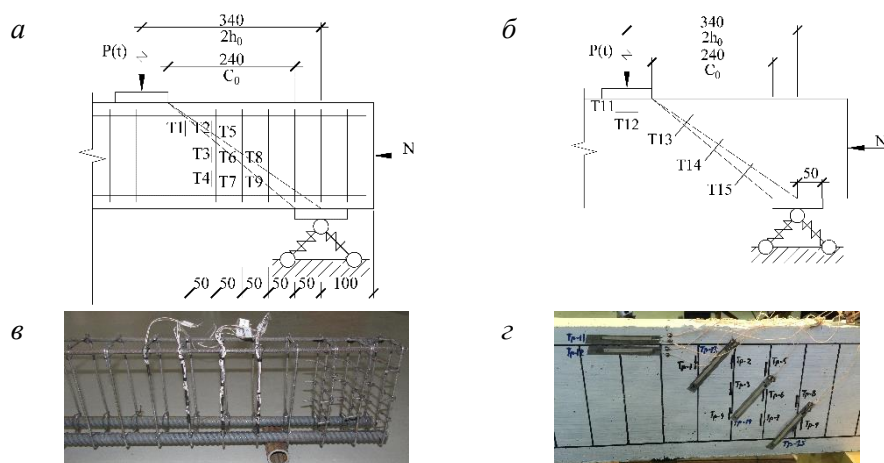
Схема расположения тензорезисторов на поперечной арматуре (а) и бетоне (б); общий вид расположения тензорезисторов на поперечной арматуре (в) и бетоне (г)
